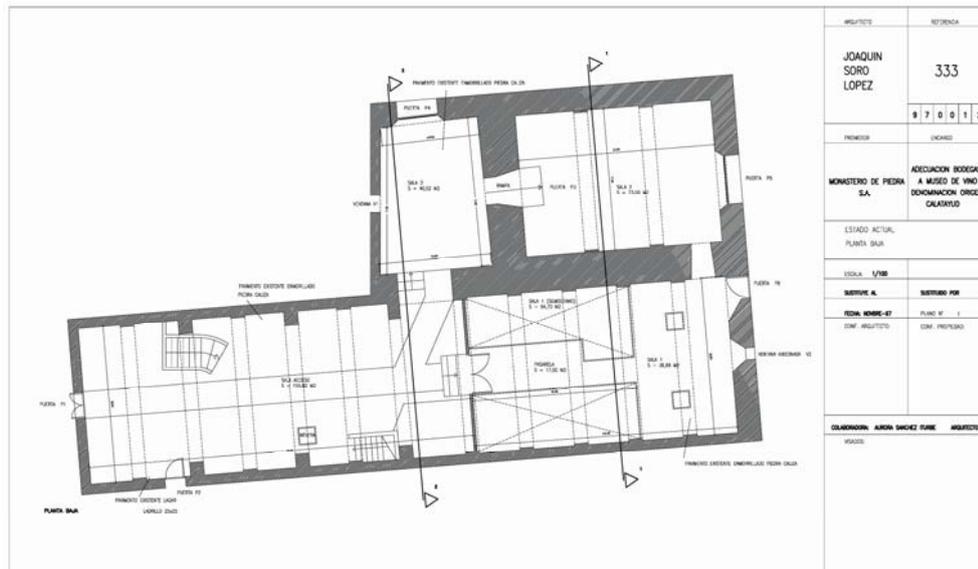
(Arch. Joaquín Soro [AJS], Proyecto Nov 1997, plano 1) ESTADO ACTUAL. PLANTA BAJA.
